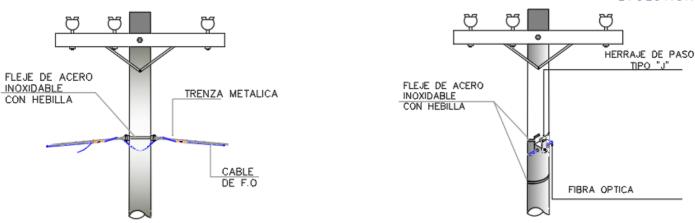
DETALLE DE INSTALACIÓN AÉREA EN POSTE DE MADERA O CONCRETO.
